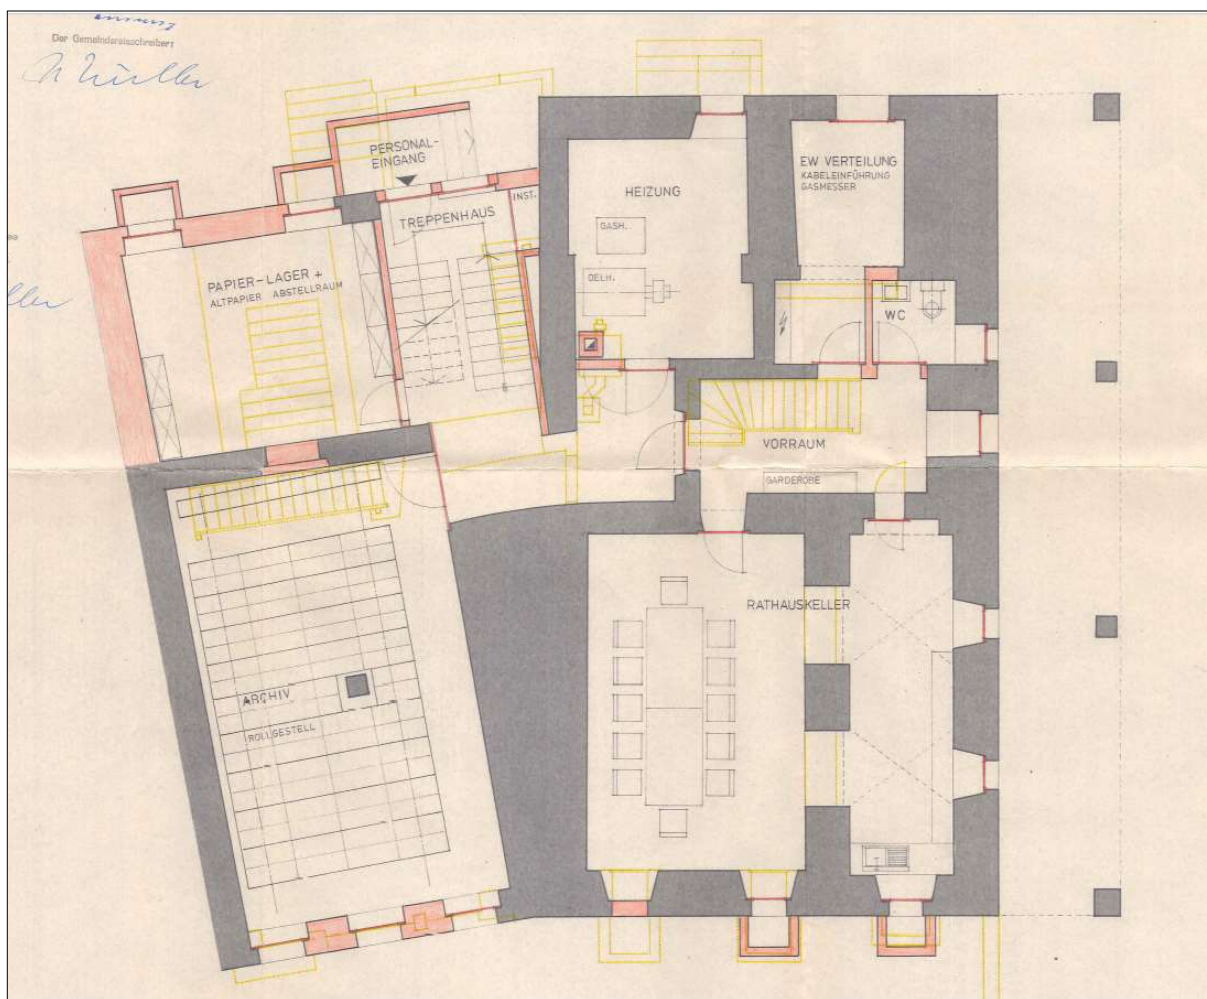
Grundriss Untergeschoss. Projektplan von 1981.¹³ Diese Planung wurde mit kleinen Abweichungen umgesetzt.
